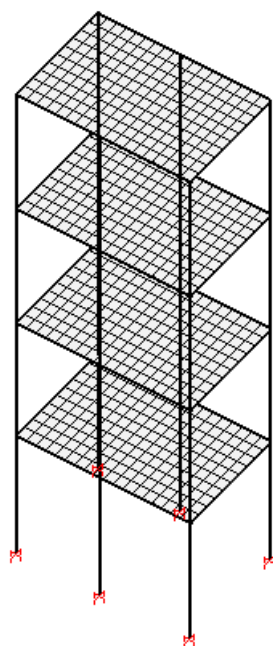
Pórtico espacial com grelha de vigas e lajes. (Fonte: TQS Informática; 2020)
